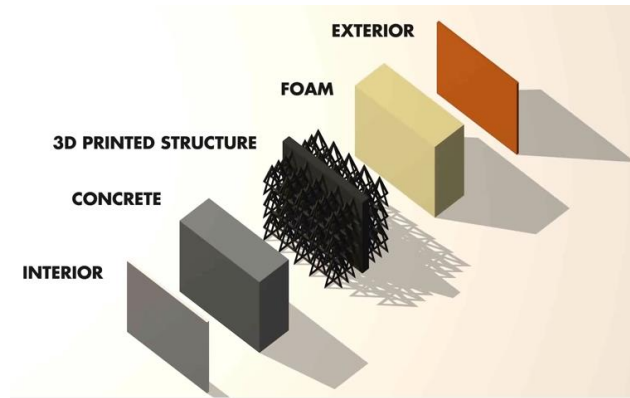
Estrutura da parede segundo o conceito da empresa [57]
